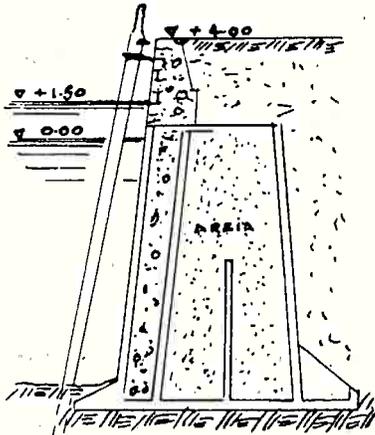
Caixões da bacia Waalhavem — Rotterdam.
